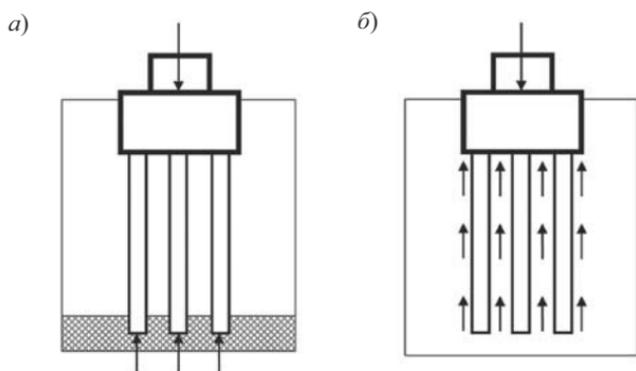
Виды свайных фундаментов: *а* – фундамент на сваях-стойках, *б* – то же на висячих сваях
